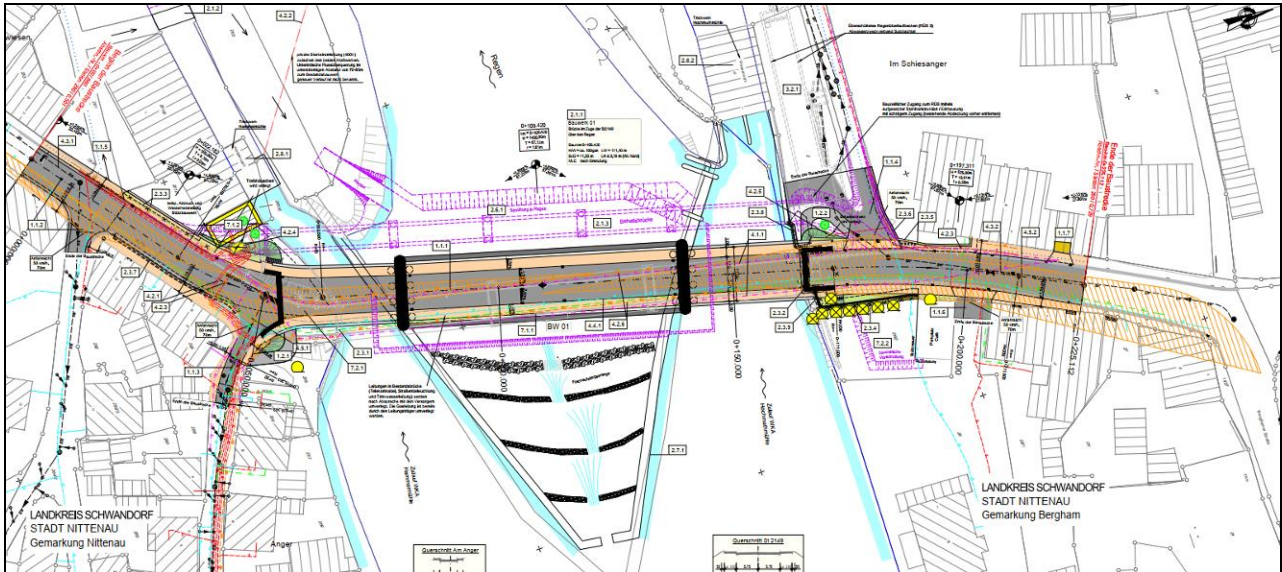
Auszug Lageplan "Ersatzneubau der Großen Regenbrücke Nittenau" (Quelle StBA Amberg-Suzbach, 14.09.2018)
